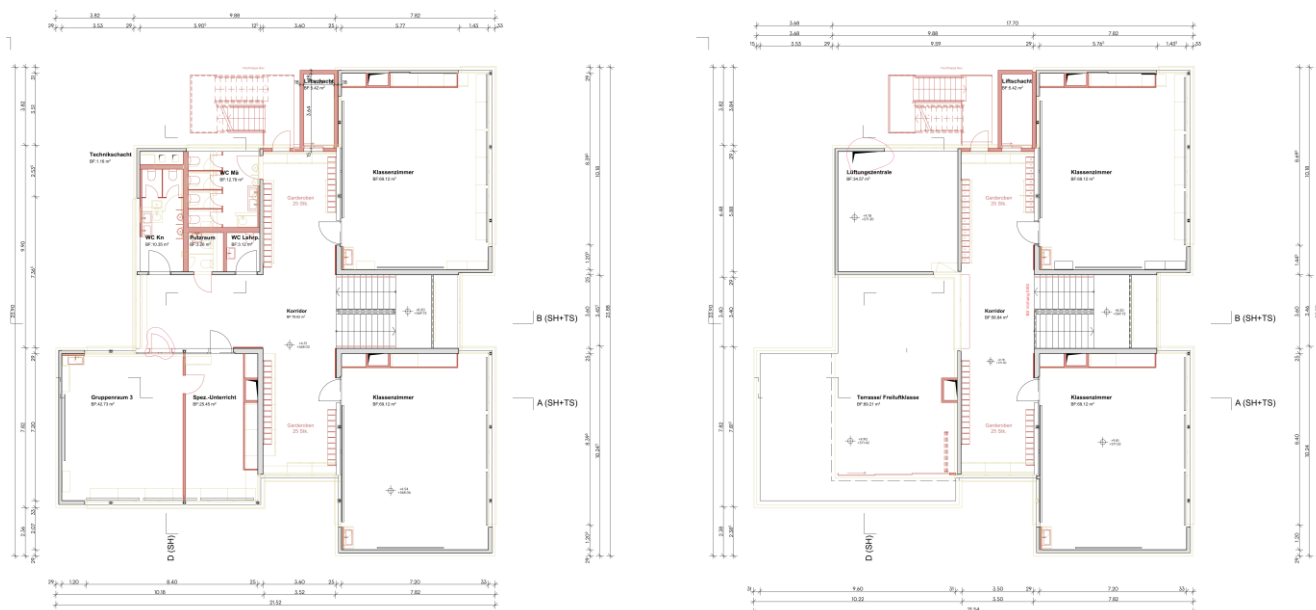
Grundriss 2. Obergeschoss (links) und 3. Obergeschoss (rechts), Gebäude 2
